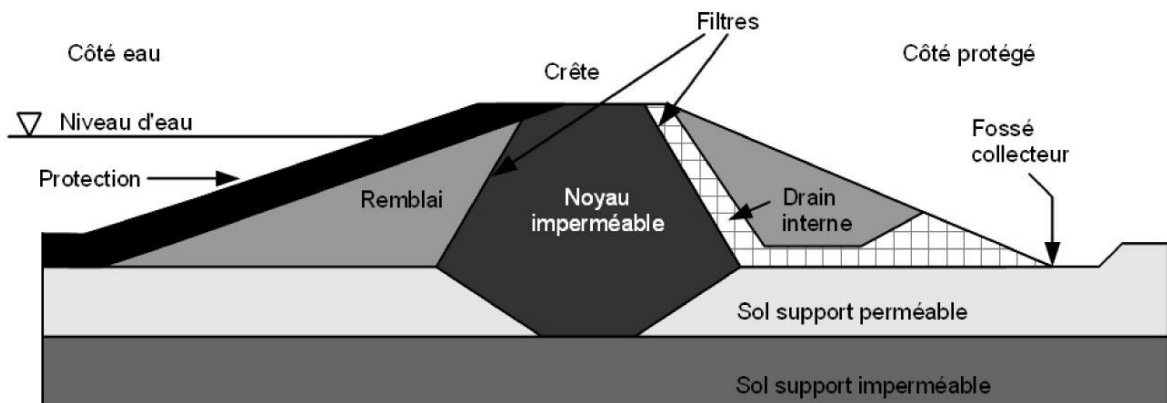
Digue zonée à noyau sur sol perméable avec ancrage d'étanchéité
